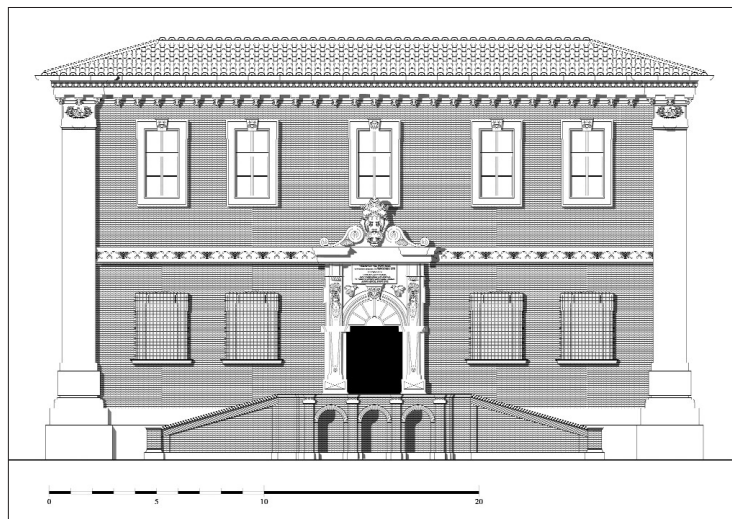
Ricostruzione del prospetto del granaio su strada Pia (elaborazione di A. Fabiani e O. Paris).
